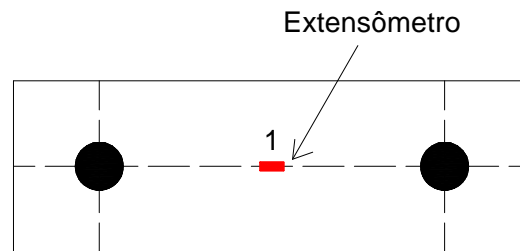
Posição do extensômetro nas chapas separadoras
